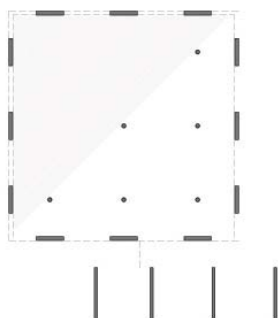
Estructura mixta de muros pantalla y pilares, nivel 2. Fuente: MCHS.
